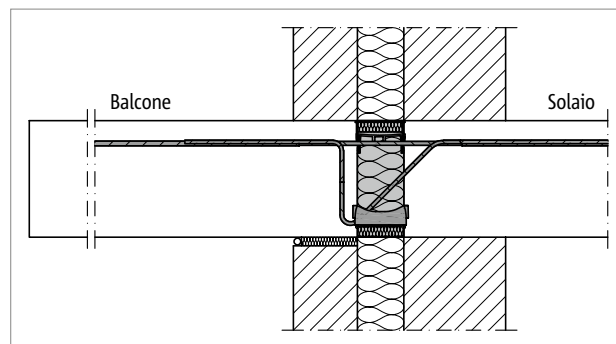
Schöck Isokorb® T tipo K: raccordo con muratura bistrato e interposto isolamento
